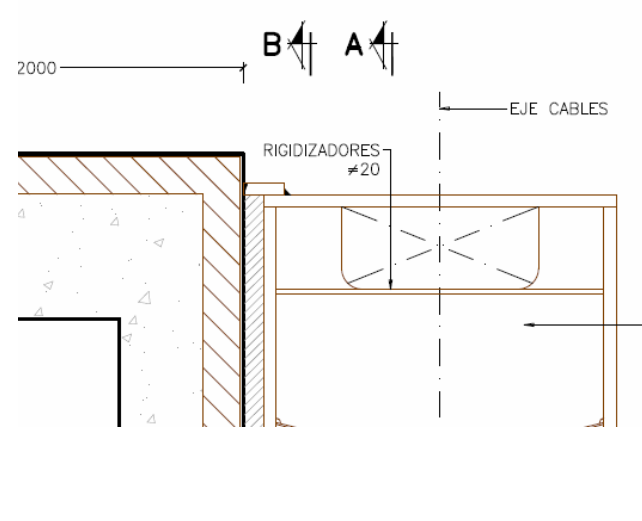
Detalle de la soldadura vertical continua entre pilono existente y ampliación.
